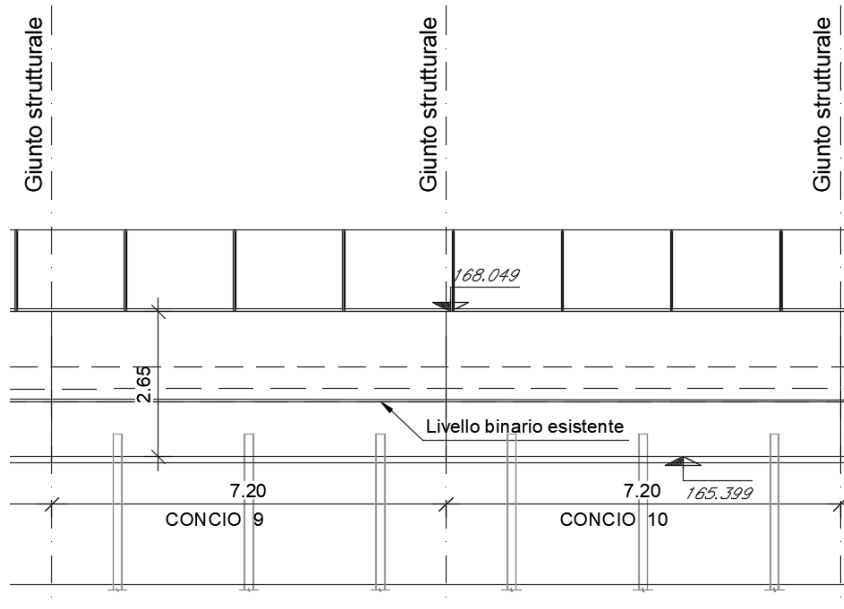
Stralcio planimetrico pensilina su "pensilina tipo 1"
